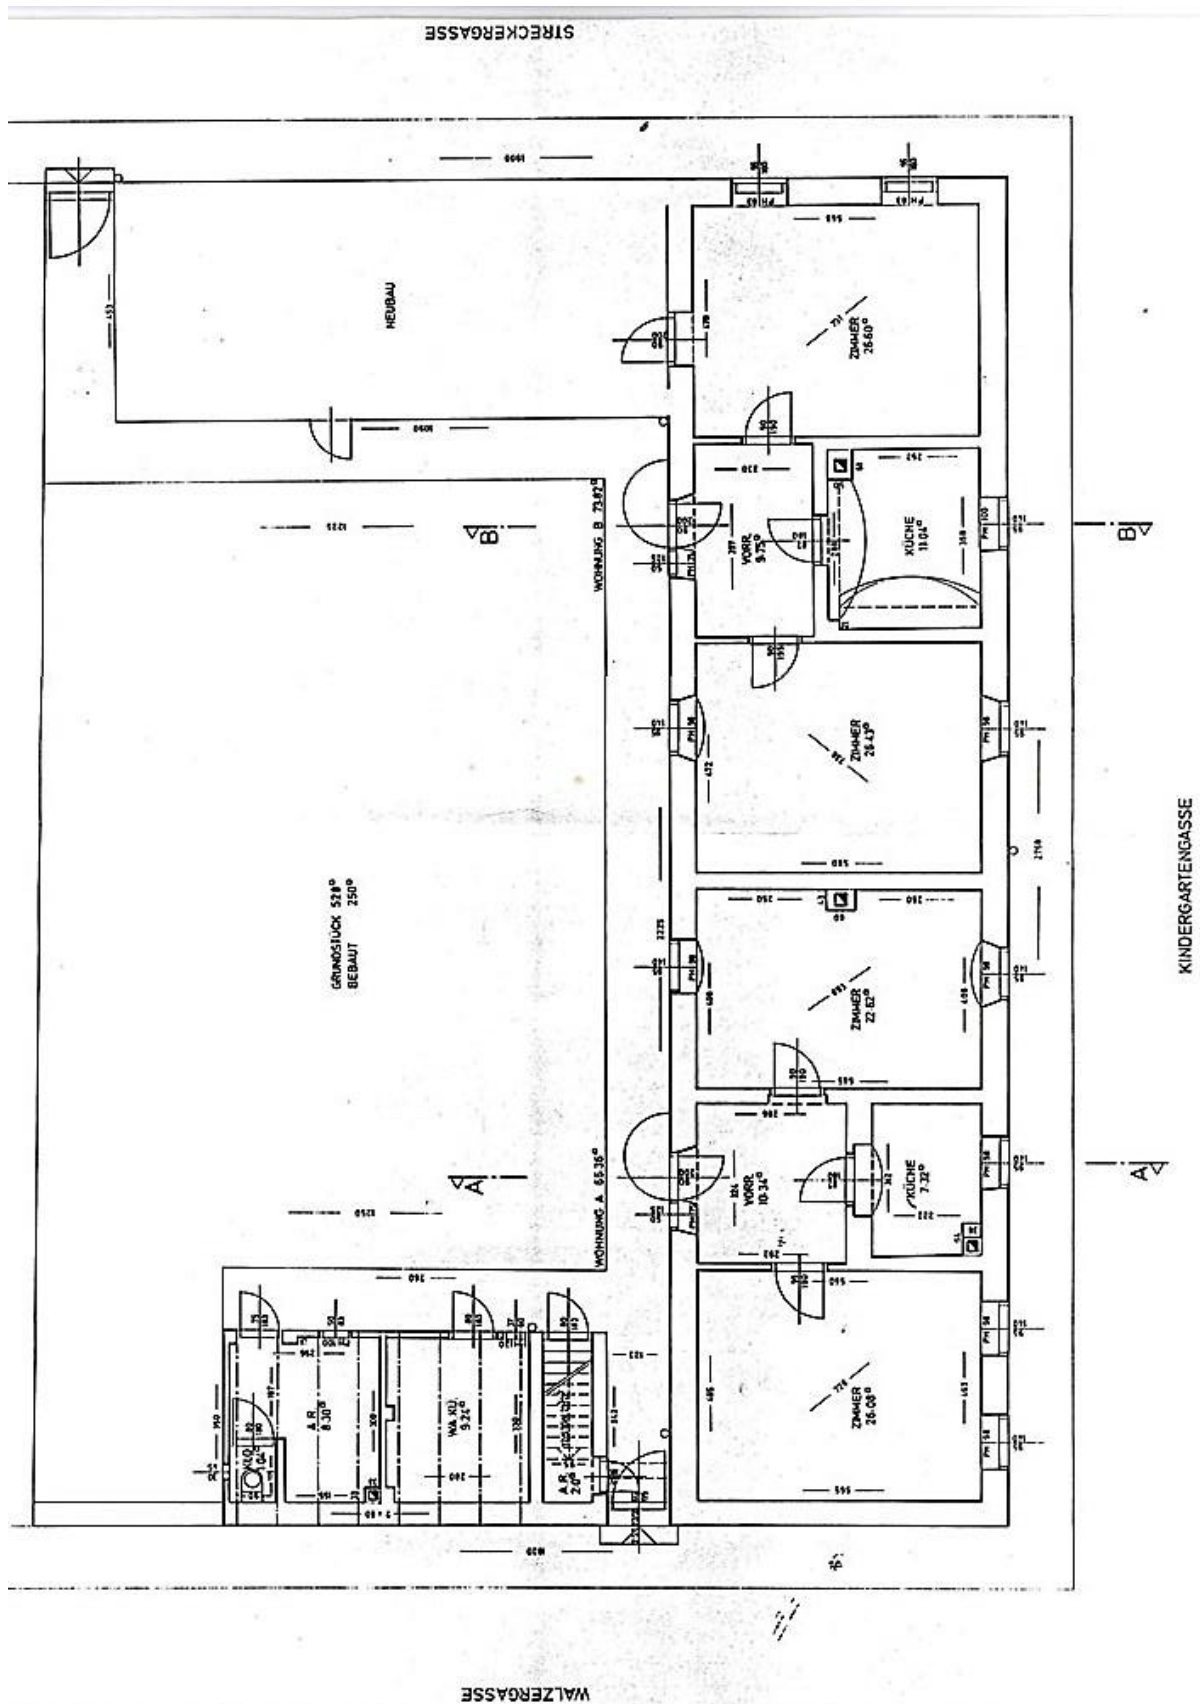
Grundriss des Hauses Streckergasse 1, entnommen dem Gutachten Manfred Wehdorns 1987, als Quelle für die Informationen zu diesem Haus sind eigene Erhebungen, Grundbuch und Bauakt angegeben. Im Bereich zur Streckergasse ist der Grundriss der Wohneinheit weitgehend erhalten, wobei die andere Gebäudehälfte durch eine abweichende Kaminposition einen zuvor durchgeführten Umbau erkennen lässt.
